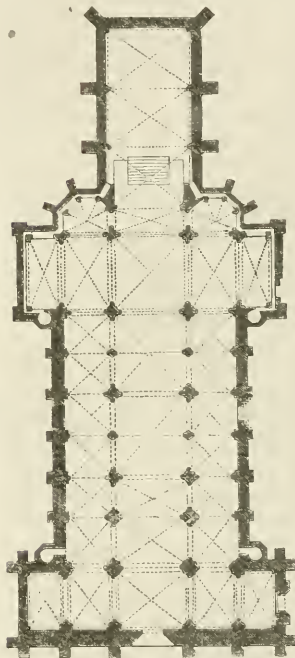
Grundriss des Münsters zu Schlettstadt.
